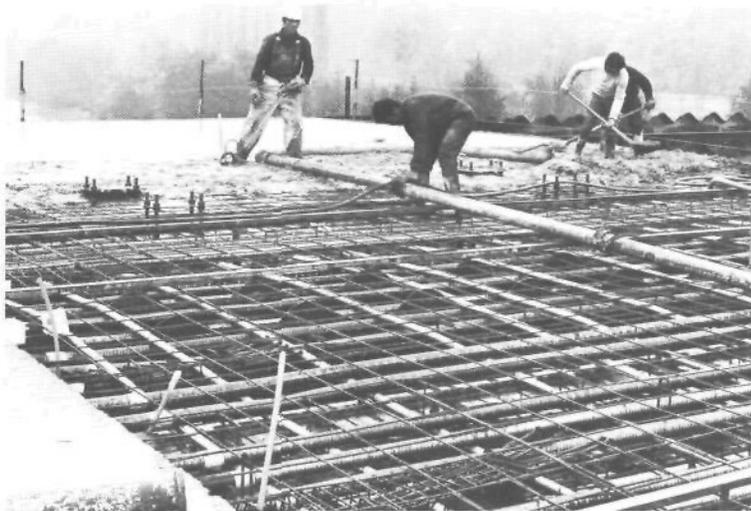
L'épaisseur de la dalle en section courante doit permettre la mise en place des deux nappes de ferrailage supérieure et inférieure et des deux nappes de câbles longitudinaux et transversaux. La précontrainte transversale sera appliquée la première. Elle permettra la solidarisation de la dalle à la structure métallique avant l'application de la précontrainte longitudinale.
